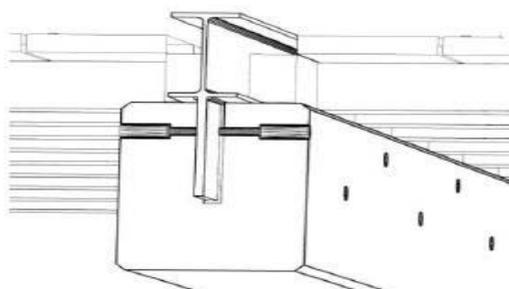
Reforço de viga através da colocação de uma chapa vertical soldada a perfil IPE ou HEA (Mariani, 2004)
